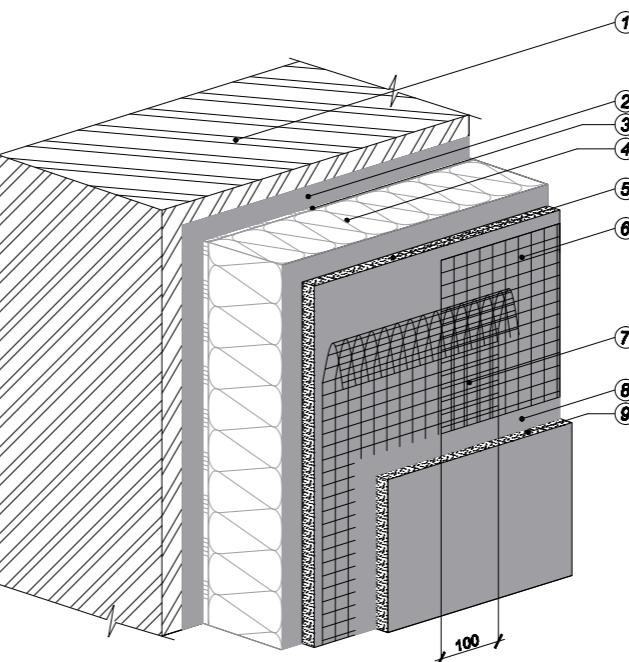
Схема соединения двух полотнищ стеклосетки на стене здания
